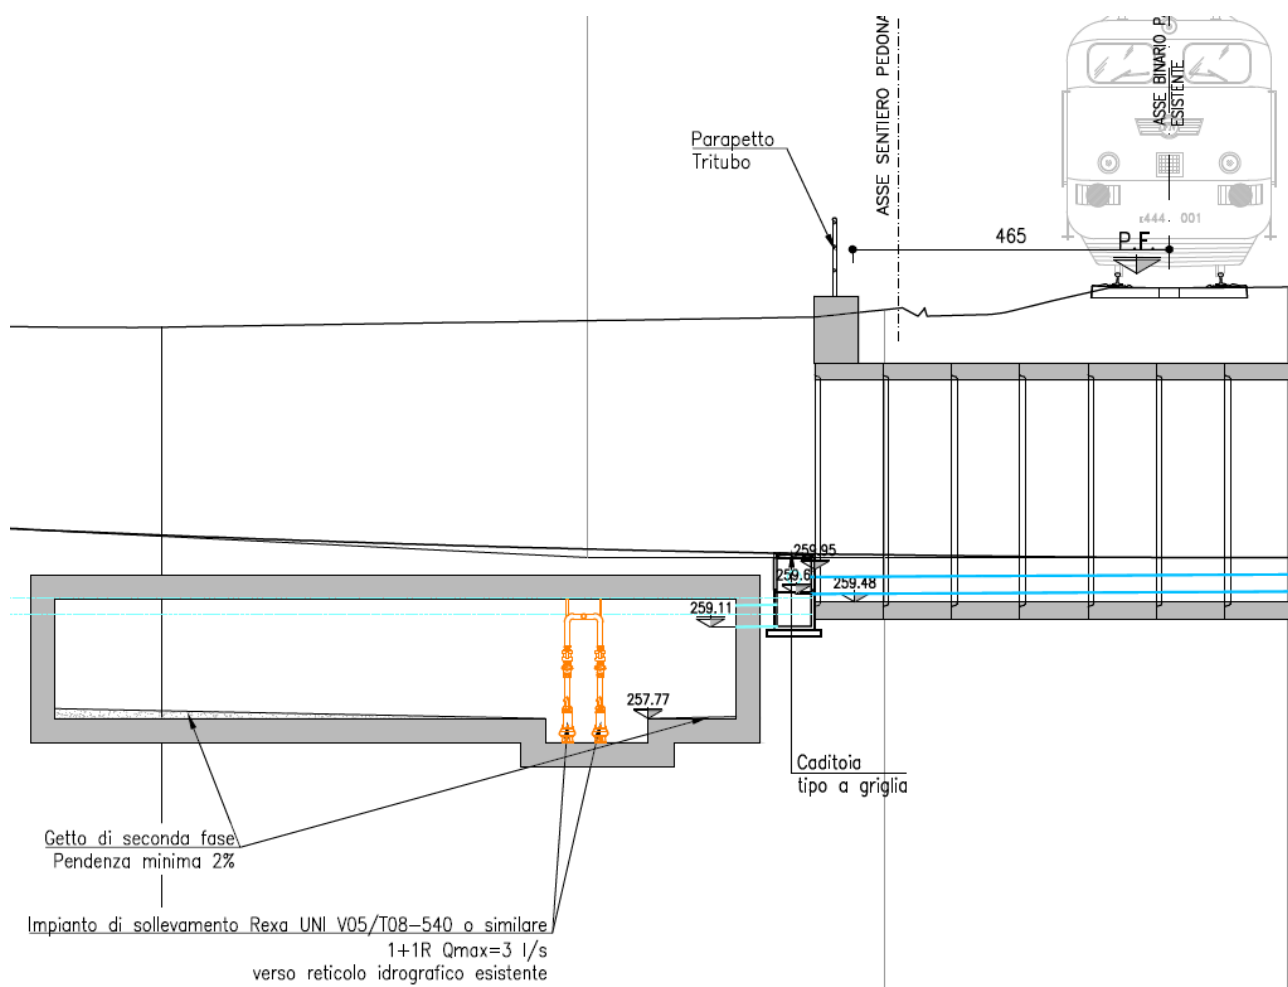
Stralcio planimetrico dell'allaccio fognario acque meteoriche in progetto - Località Braghe
